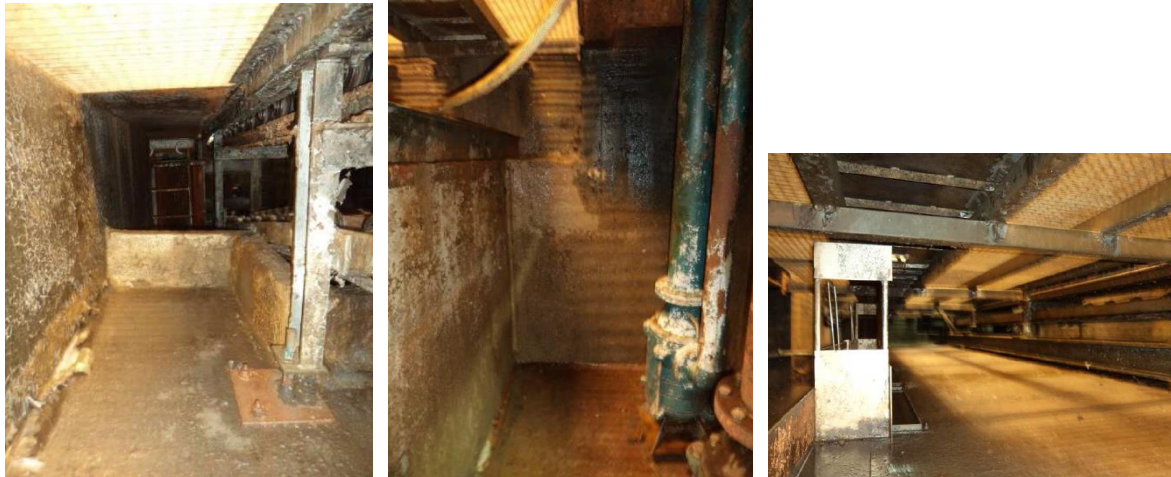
Condição actual do tanque (transportador, bombagem e filtragem).
